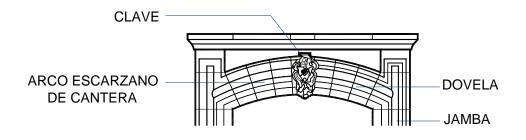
Detalle del cerramiento del portón de la vivienda.
